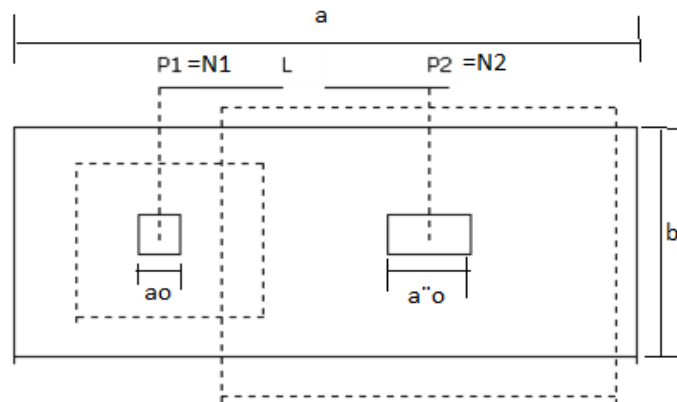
, Esquema de zapata aislada, Libro José Calavera Estructuras de cimentación
